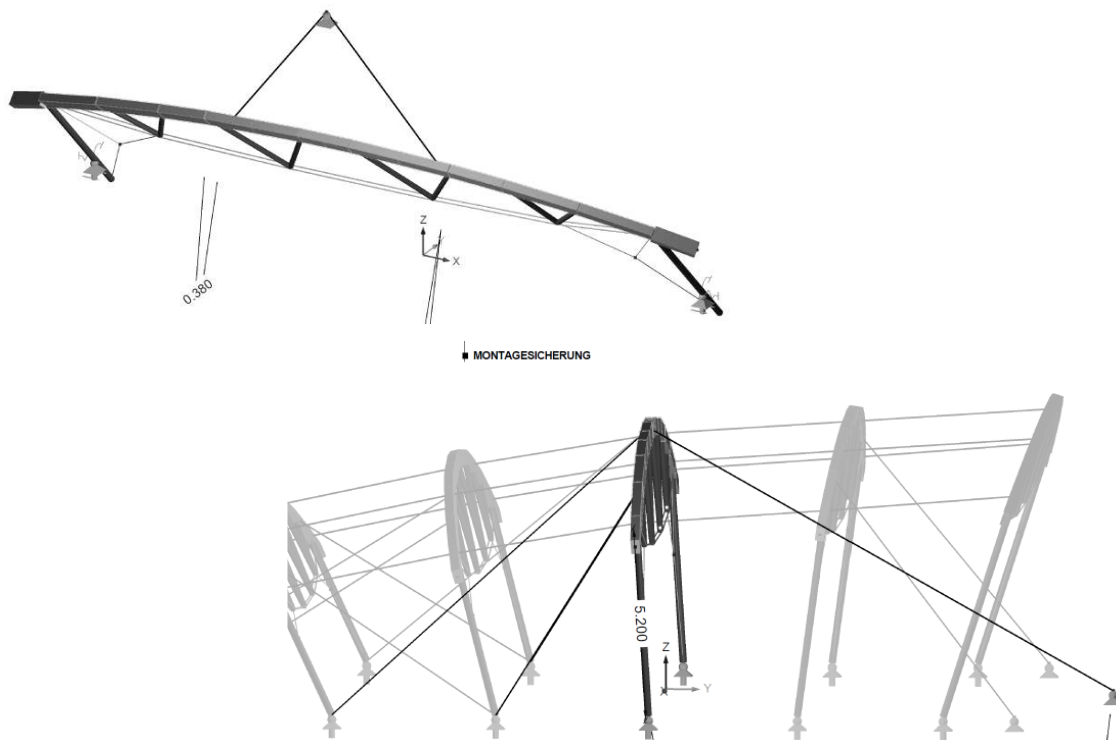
(PSS) : bis eine leichte Holz- Stahlkonstruktion steht sind Montagebelange zu beachten
